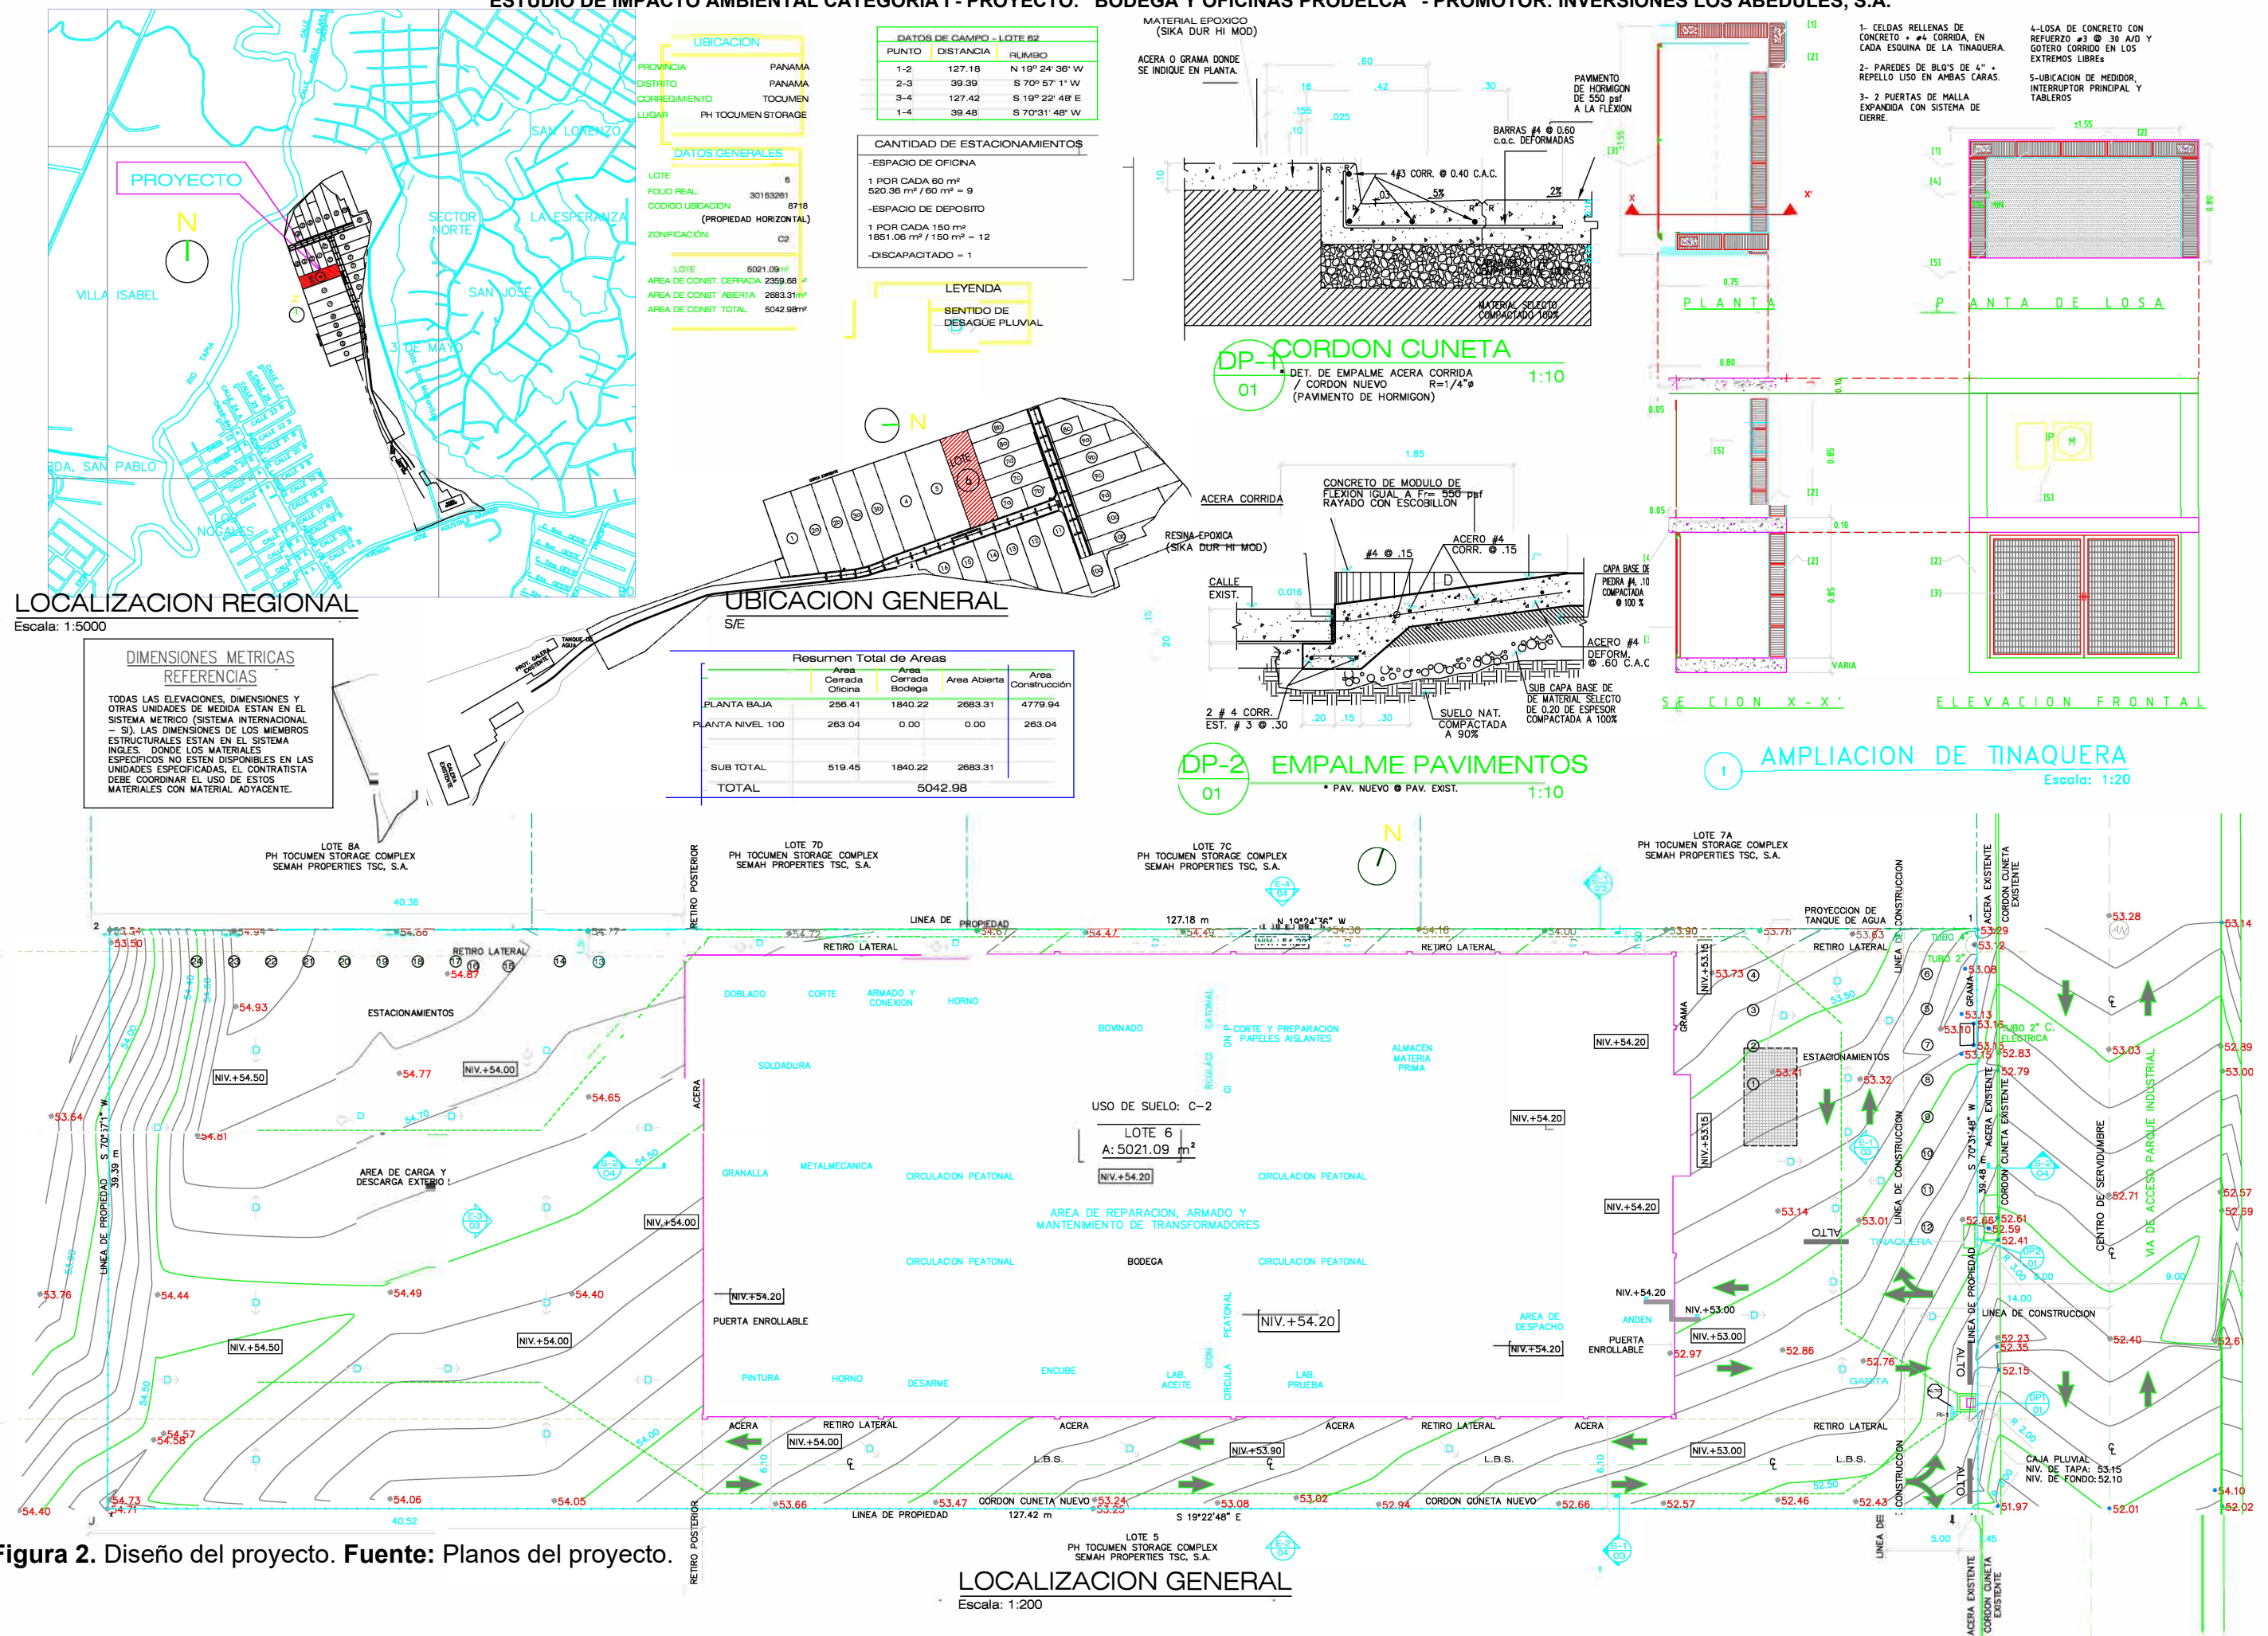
Diseño del proyecto. Fuente: Planos del proyecto.
